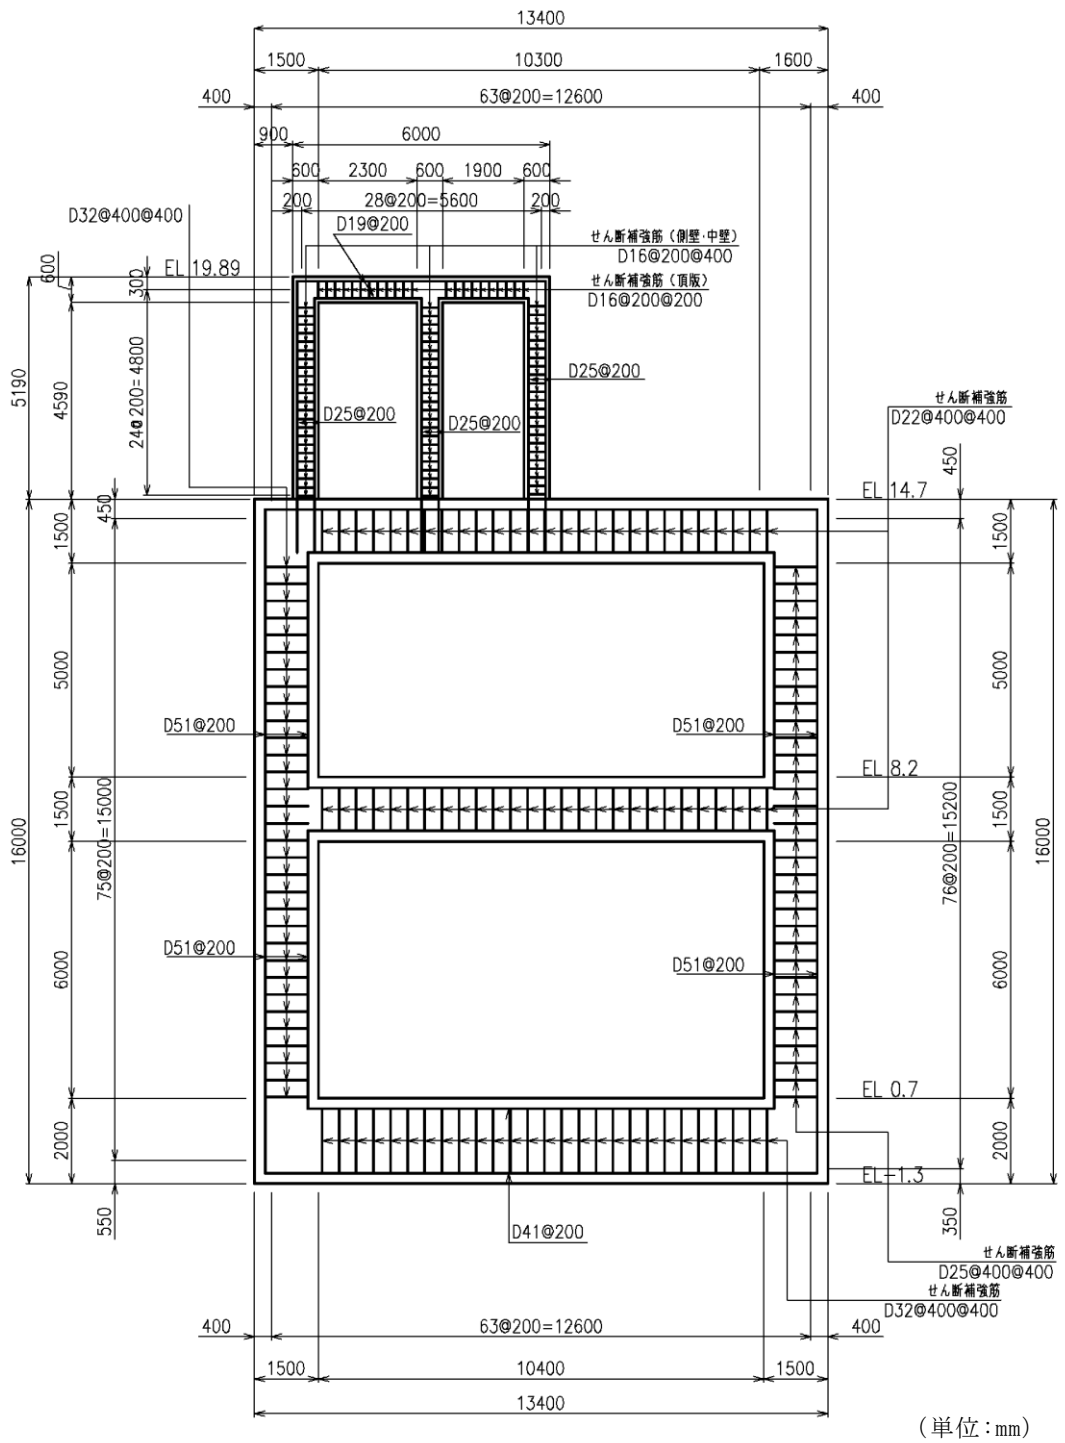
低圧原子炉代替注水ポンプ格納槽 概略配筋図 (E-E 断面)
